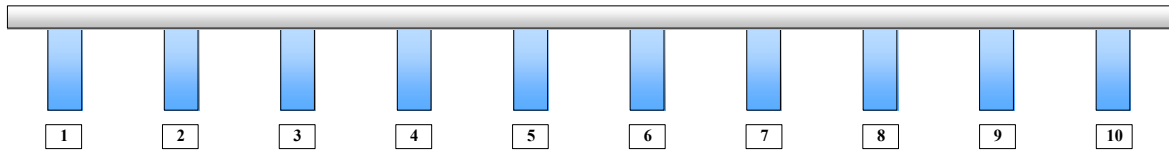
Ouvrage n°1 à poutres rectangulaires identiques
